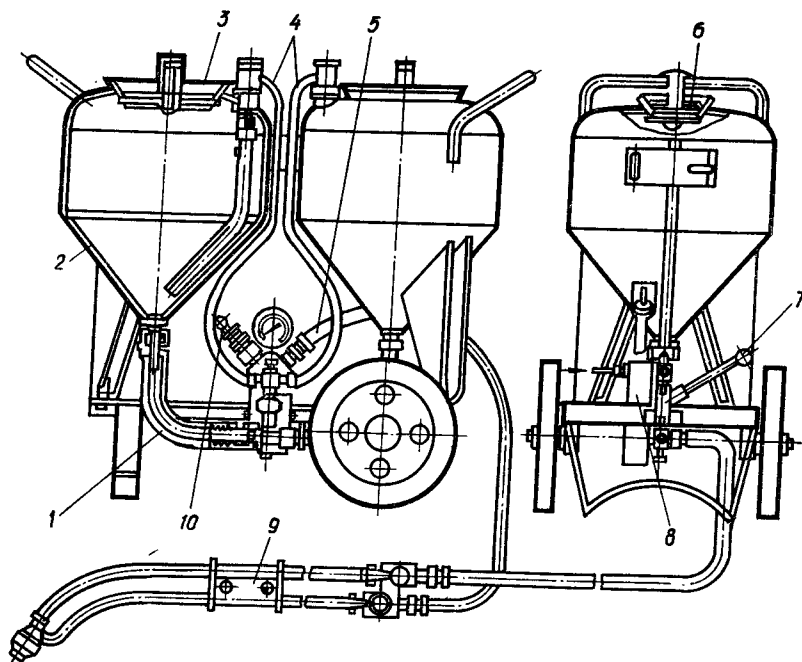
Установка для нанесения жидкой шпаклевки СО-21А:
